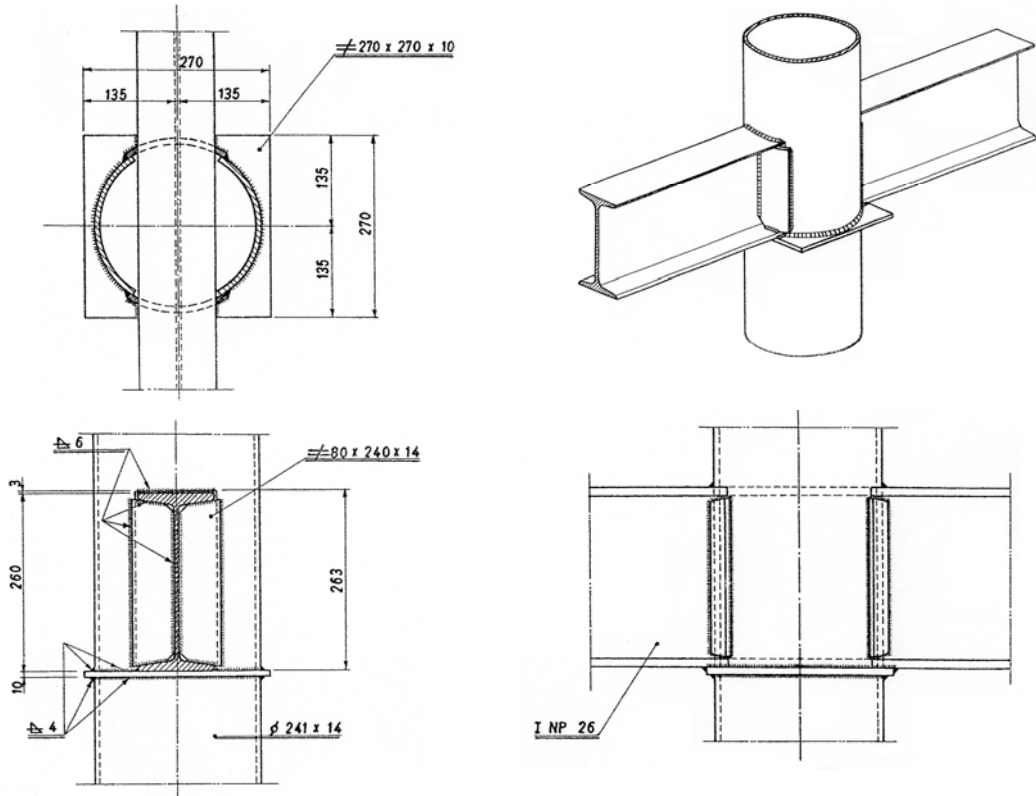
Bir çerçevenin kenar kolon bağlantı detayı [35]
